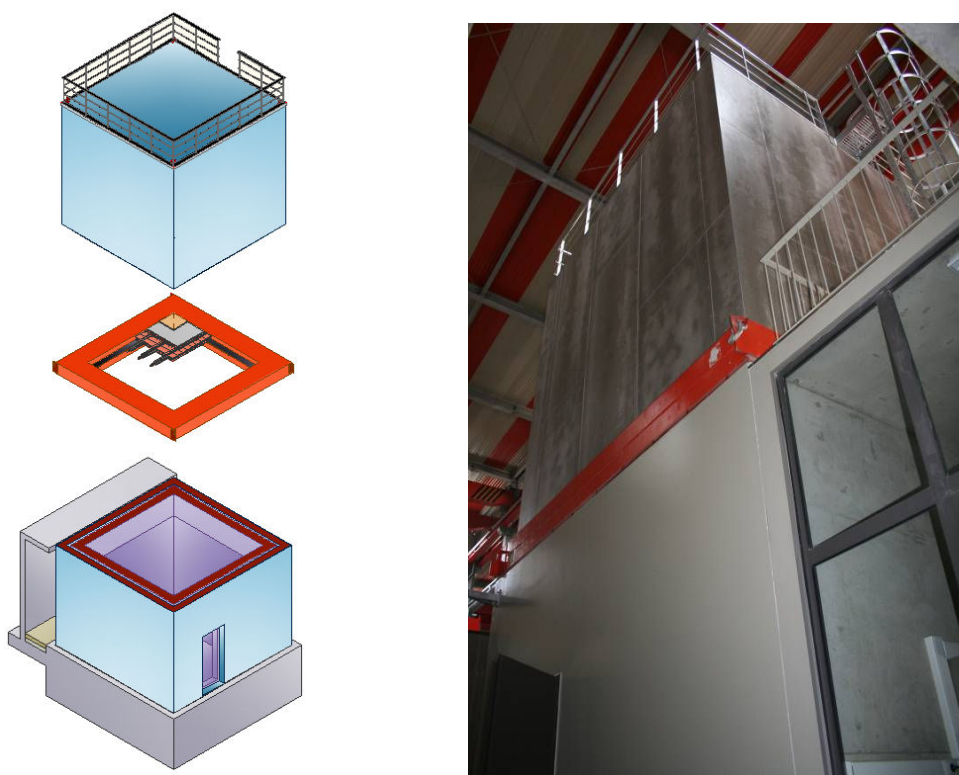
Câmaras verticais de ensaio: a) esquema geral do sistema das câmaras verticais; b) fotografia das câmaras com um provete instalado.
